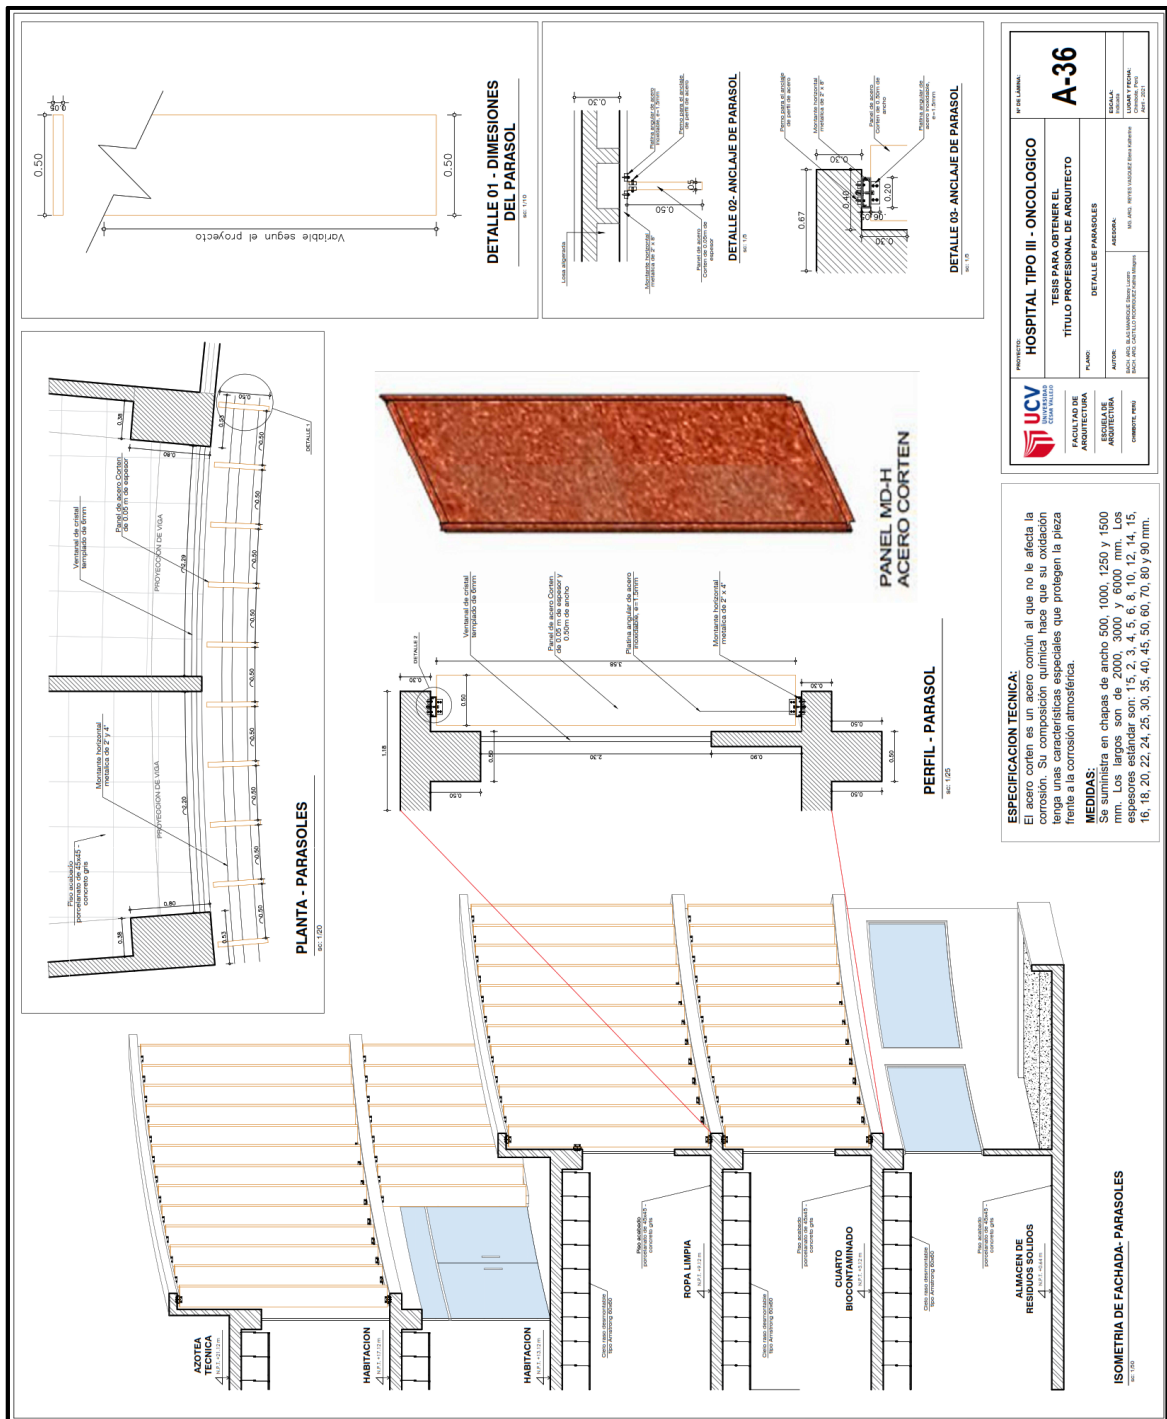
Plano de Detalle Constructivo - Parasoles
